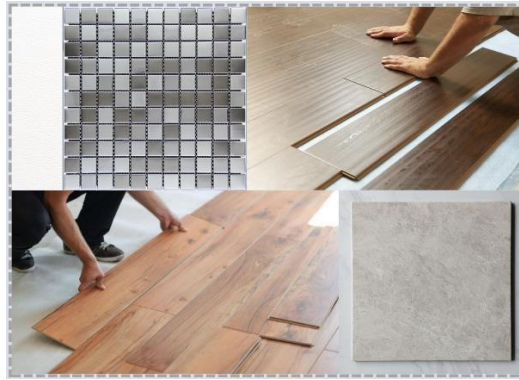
Keramik Pada Sisi Outdoor / Semi-Outdoor Bangunan
